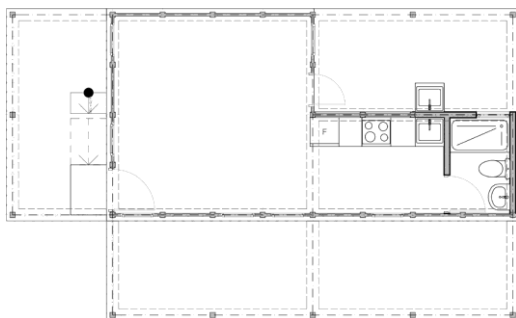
Figura XI. Planimetría de la vivienda perfectible tipo 2.
